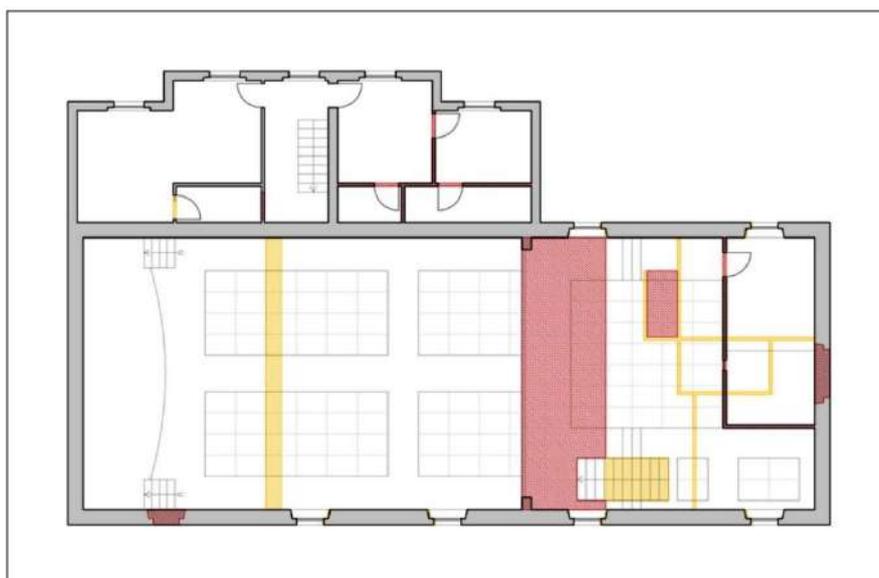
Pianta Piano Primo, Stato Sovrapposto, 1978, 1° Progetto
